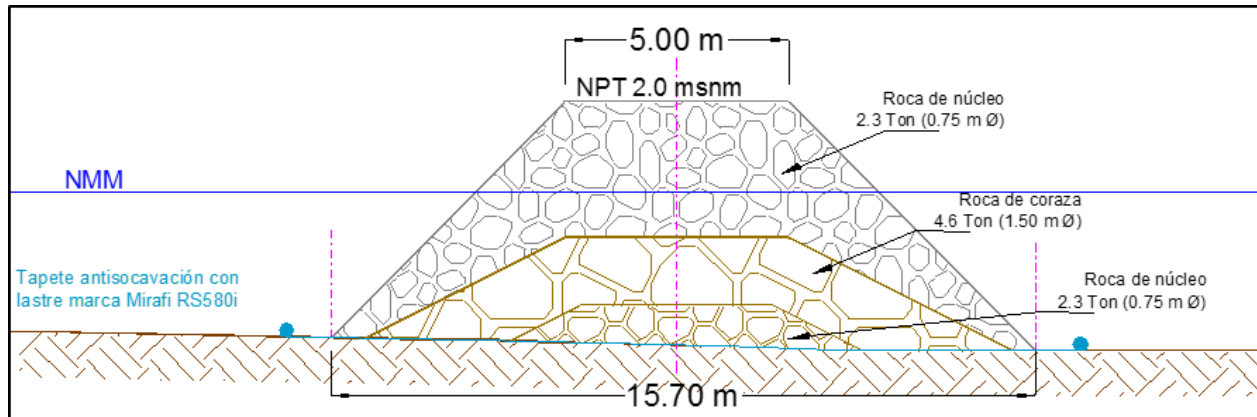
Sección tipo pedraplén y núcleo de rompeolas 1.
